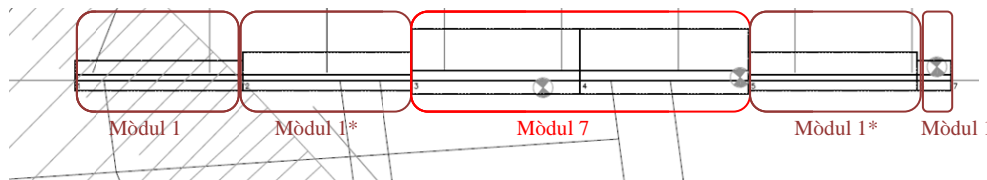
Plànol núm.18.1 full 6 Mur 5 planta.
